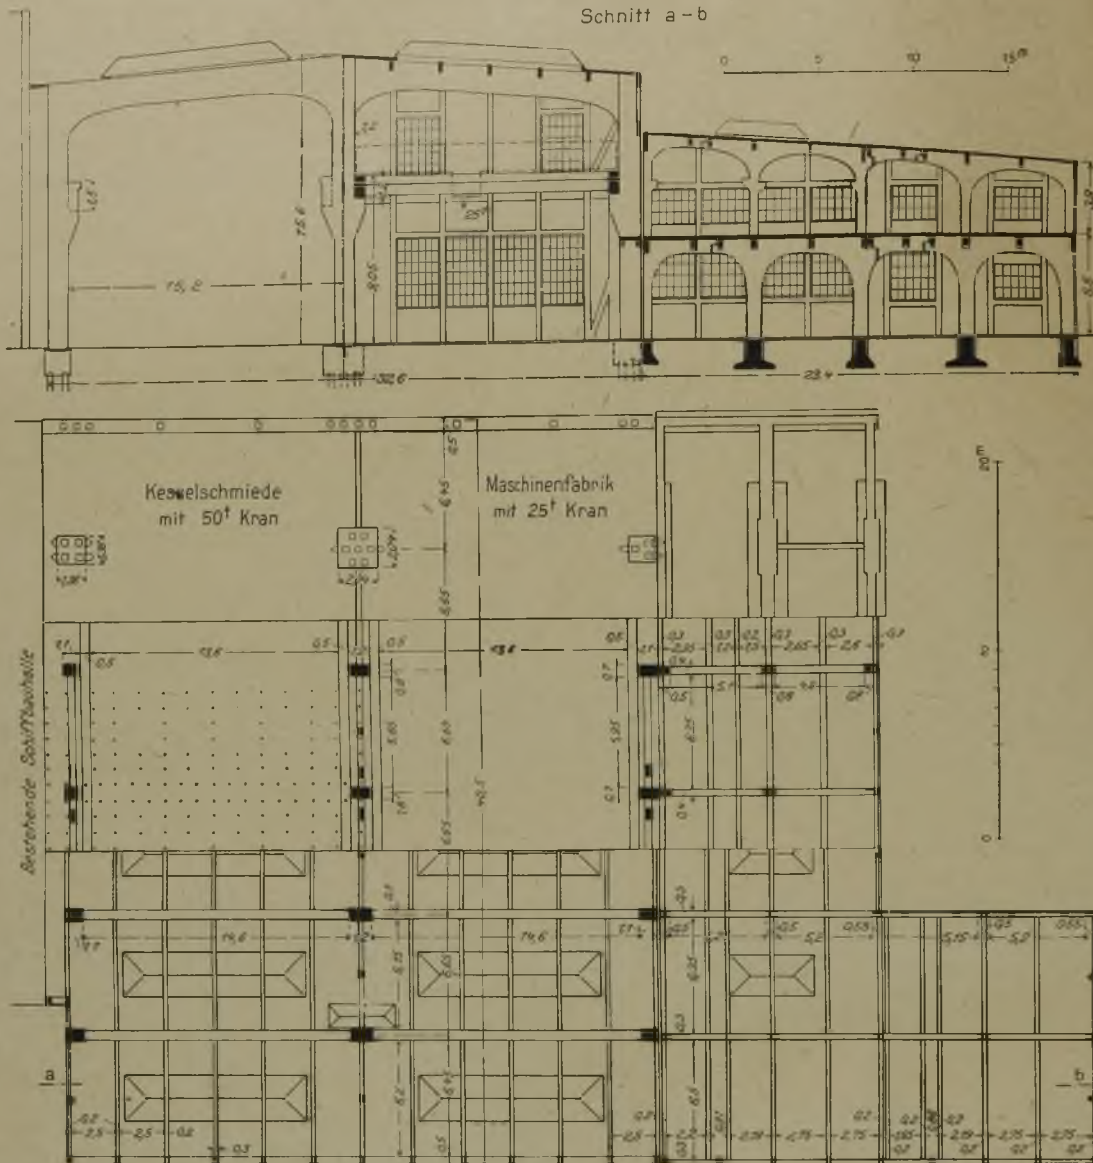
u 2. Grundrisse und Schnitt der Kesselschmiede usw.
